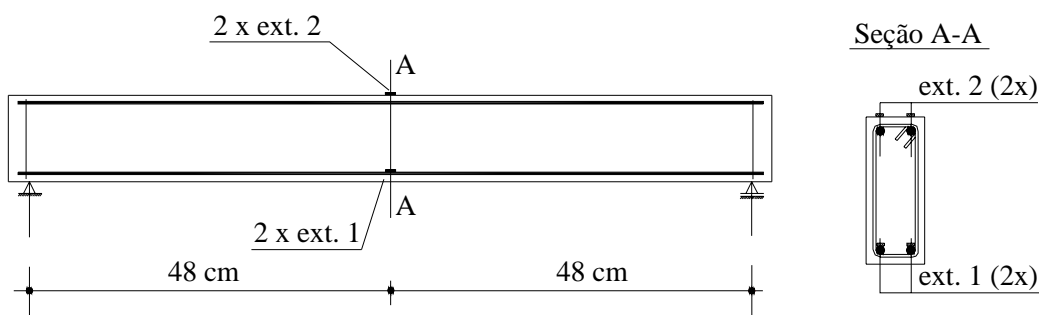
Posição esquemática dos extensômetros colados no aço e no concreto.
